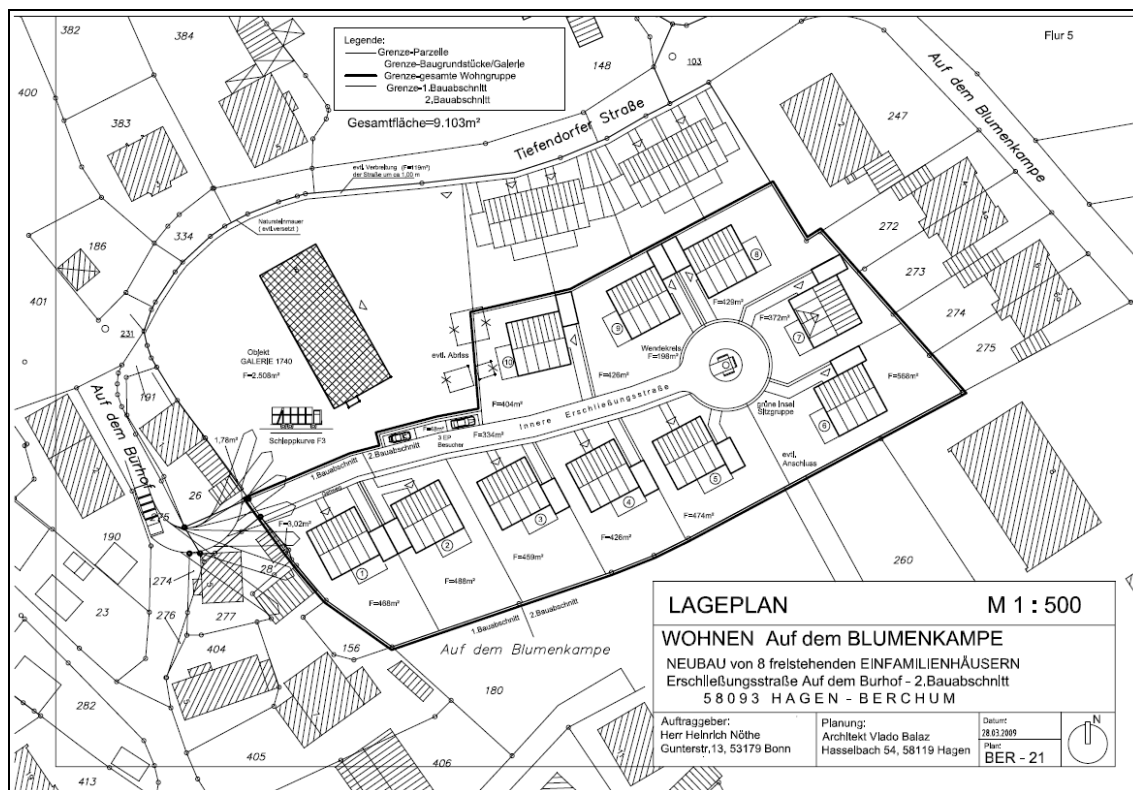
Lageplan mit Entwurf, unmaßstäblich verkleinert
